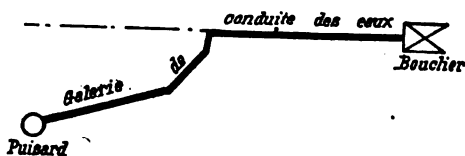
Tracé en plan de la galerie de conduite des eaux.
